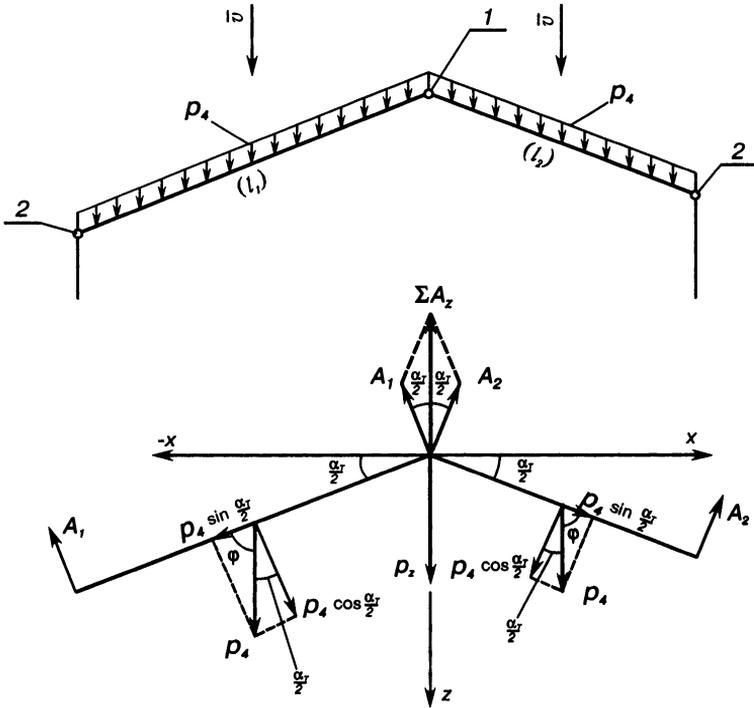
Схема нагрузок на угловую опору от давления ветра на провода при одинаковой высоте точек подвеса
